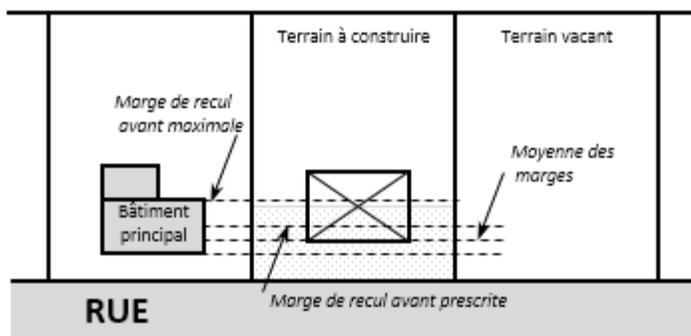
Implantation d'un bâtiment principal adjacent à un seul terrain construit
